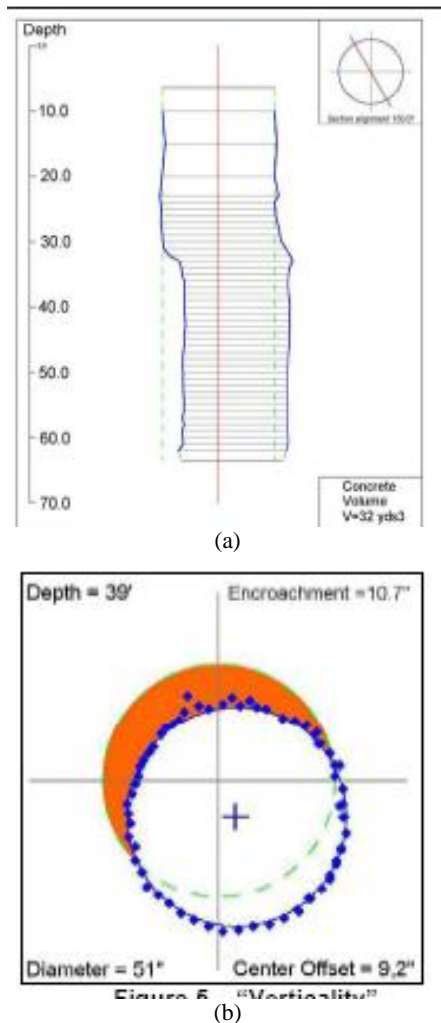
, a) Perfil en 2D del fuste de la pila; b) Planta del desplazamiento de la pila
